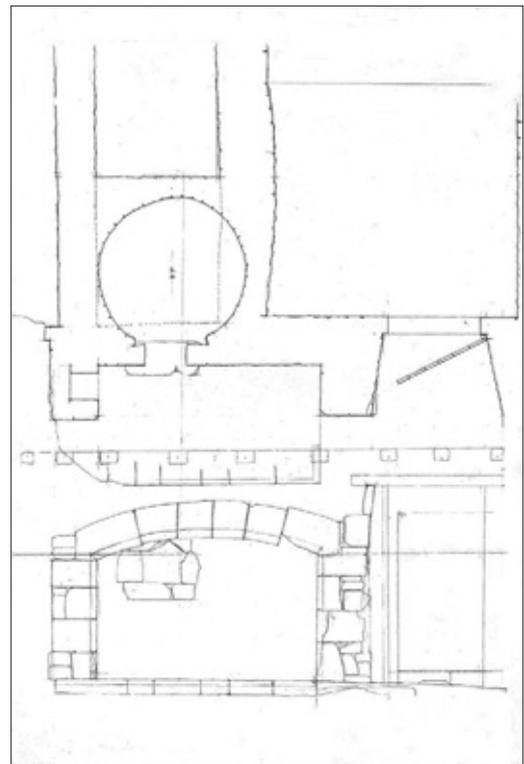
PLAN ET ELEVATION DE LA CHEMINÉE de la pièce 3. *Dessin Ch. Darles.
